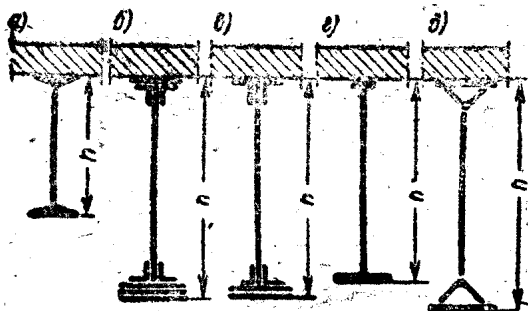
与钢筋混凝土板共用作用的鋼梁截面类型
